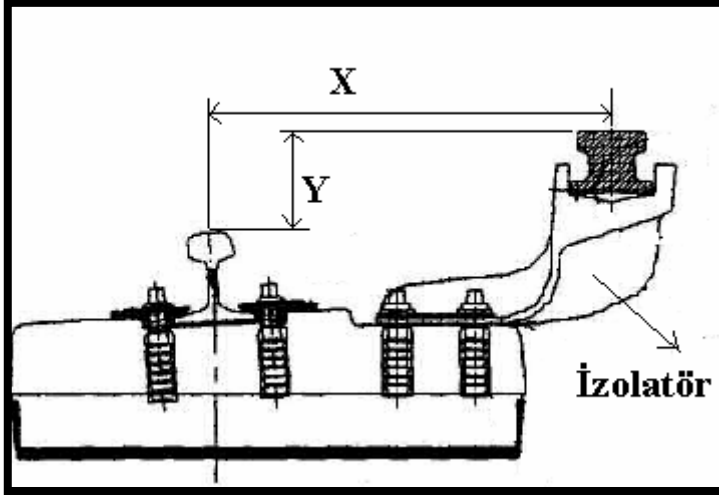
3.Ray Besleme Bağlantısı Takımı ve 3.Raya Montajı
